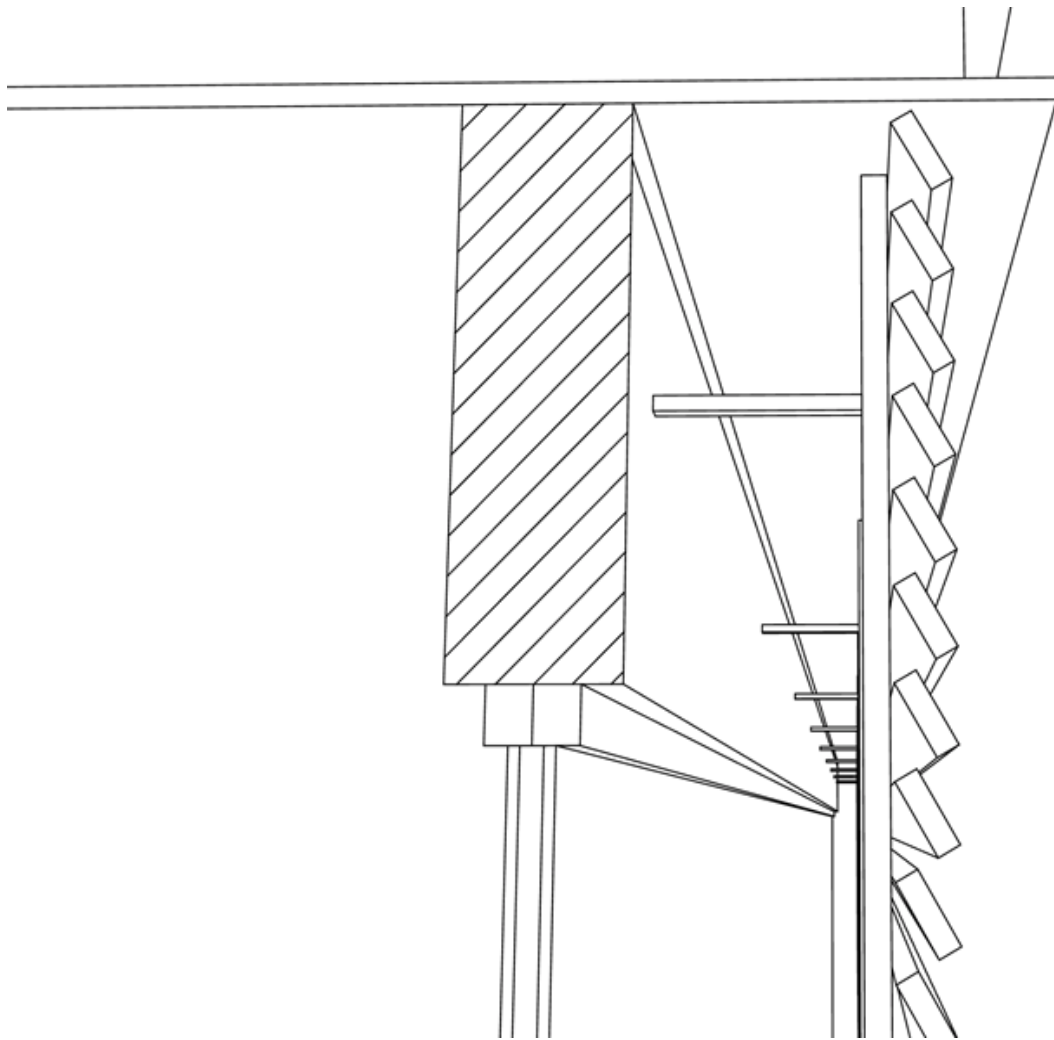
Criterio constructivo, uso de celosías en fachada como quebra soles. Fuente: Elaboración propia, 2021
